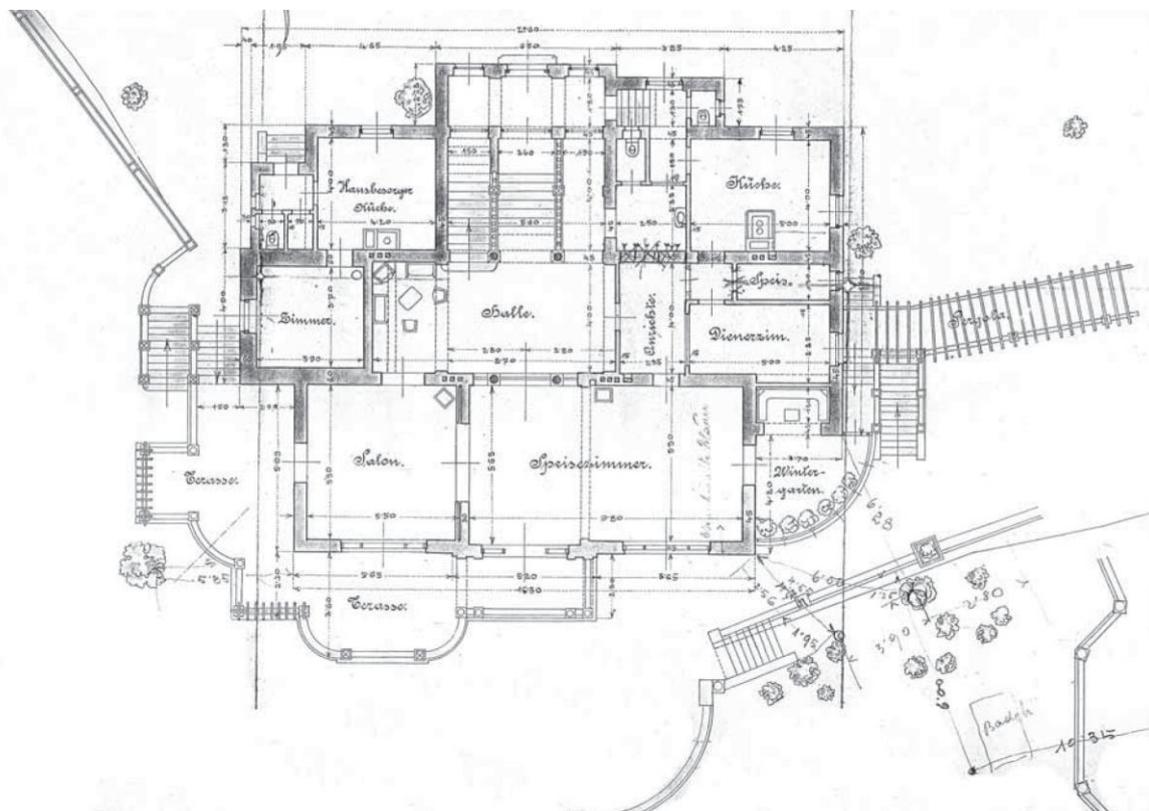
Villa Münz, Grundriss, 1911
